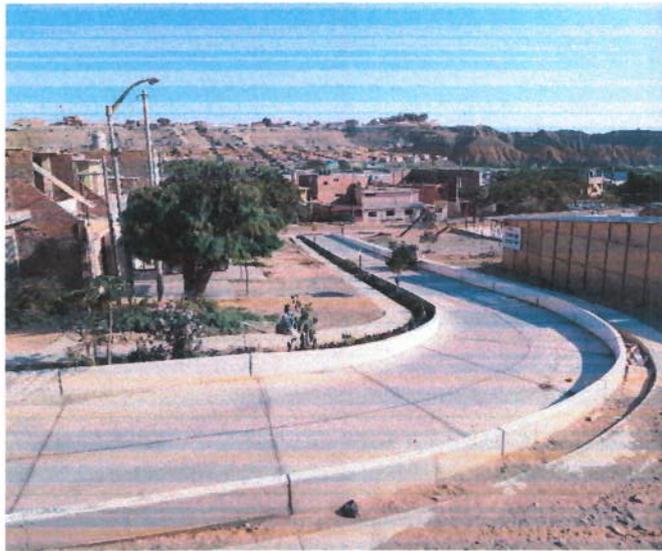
VISTA DE. CALLE VEREDA 17 DISEÑADA Y PAVIMENTADA COMO CANAL VIA
